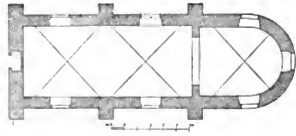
Dobřív. Grundriss der Friedhofskirche.
